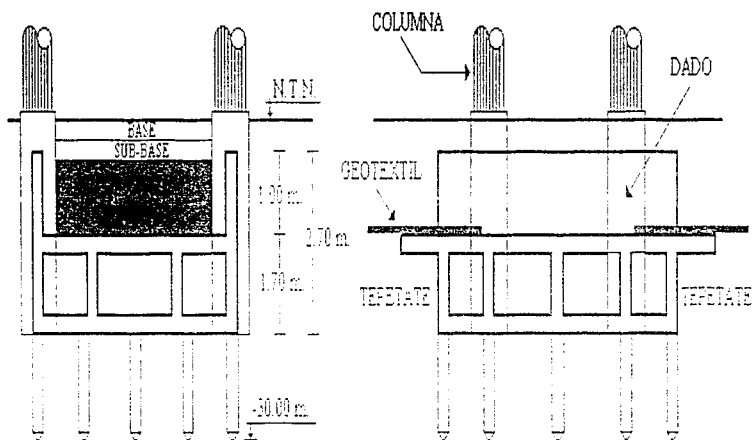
Colocación del geotextil sobre el cajón de cimentación.
